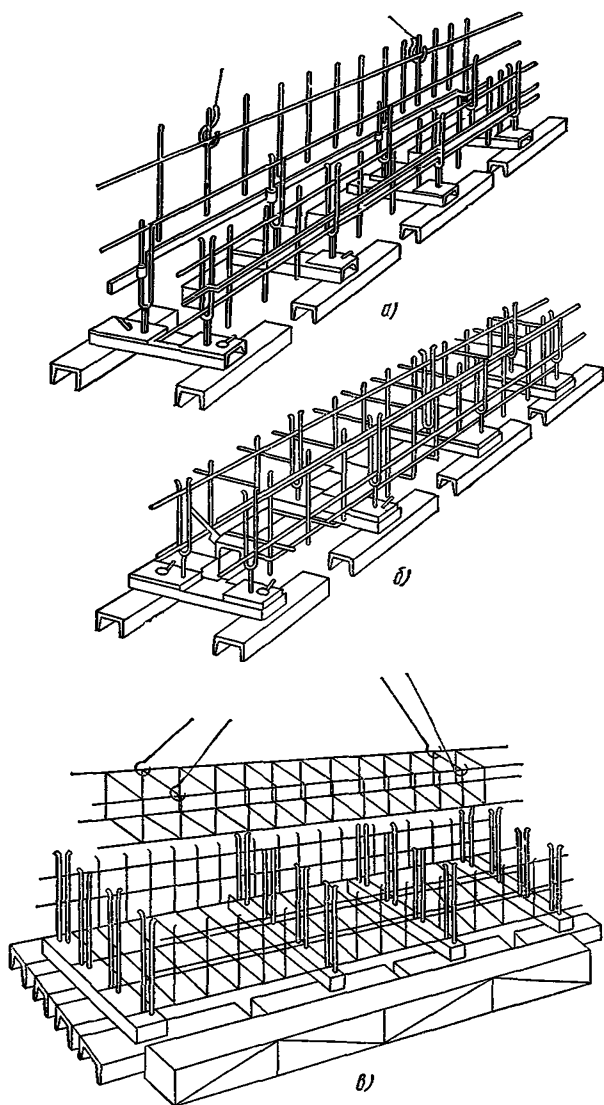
Кондуктор для сварки и сборки каркаса:
